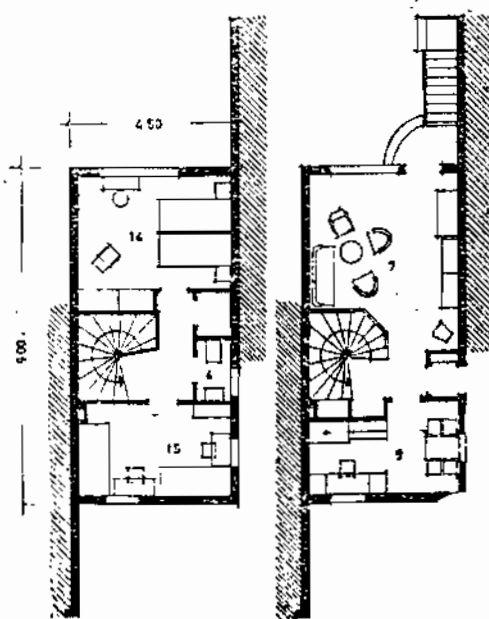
Vaziyet planını şekil 118 de gördüğümüz yerleşmede kullanılan mesken tiplerinden sıra evlere ait olan bir tipe ait kat planlarına aittir.
